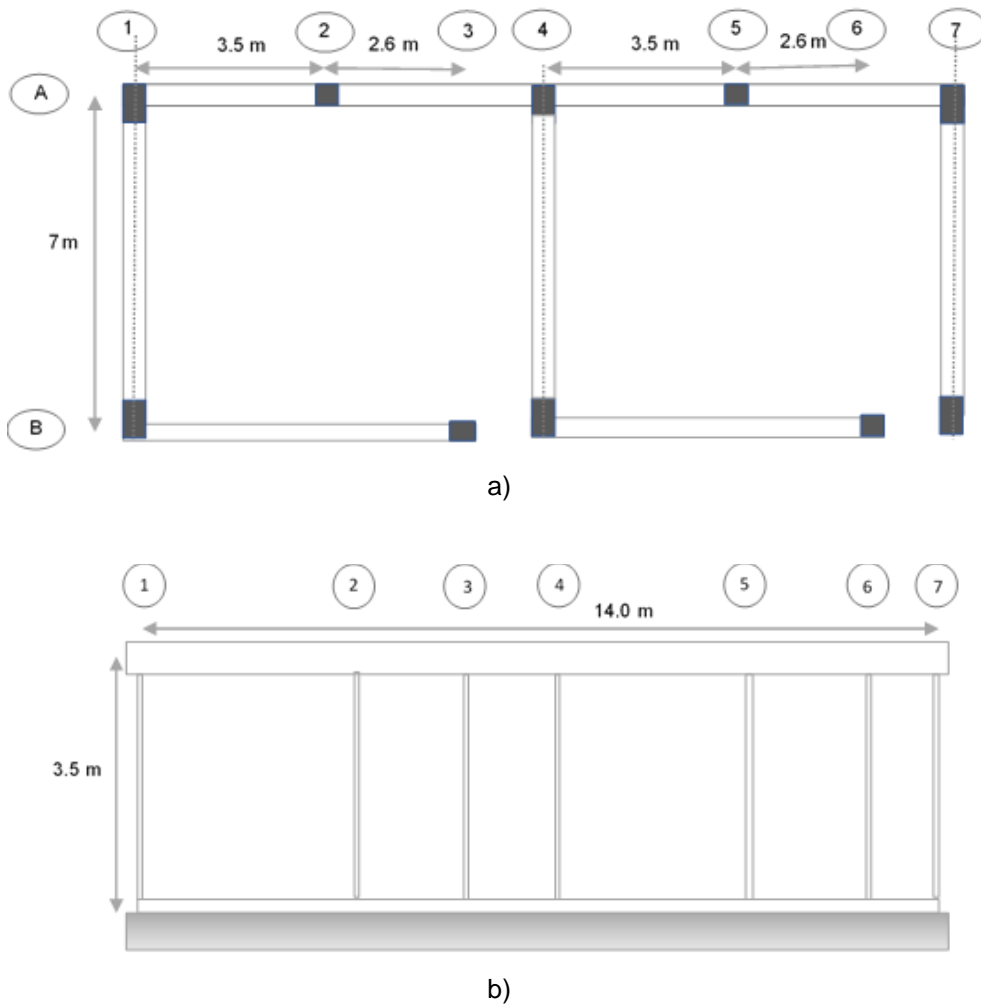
a) Planta b) Alzado de la escuela en el municipio de Tetela del Volcán
